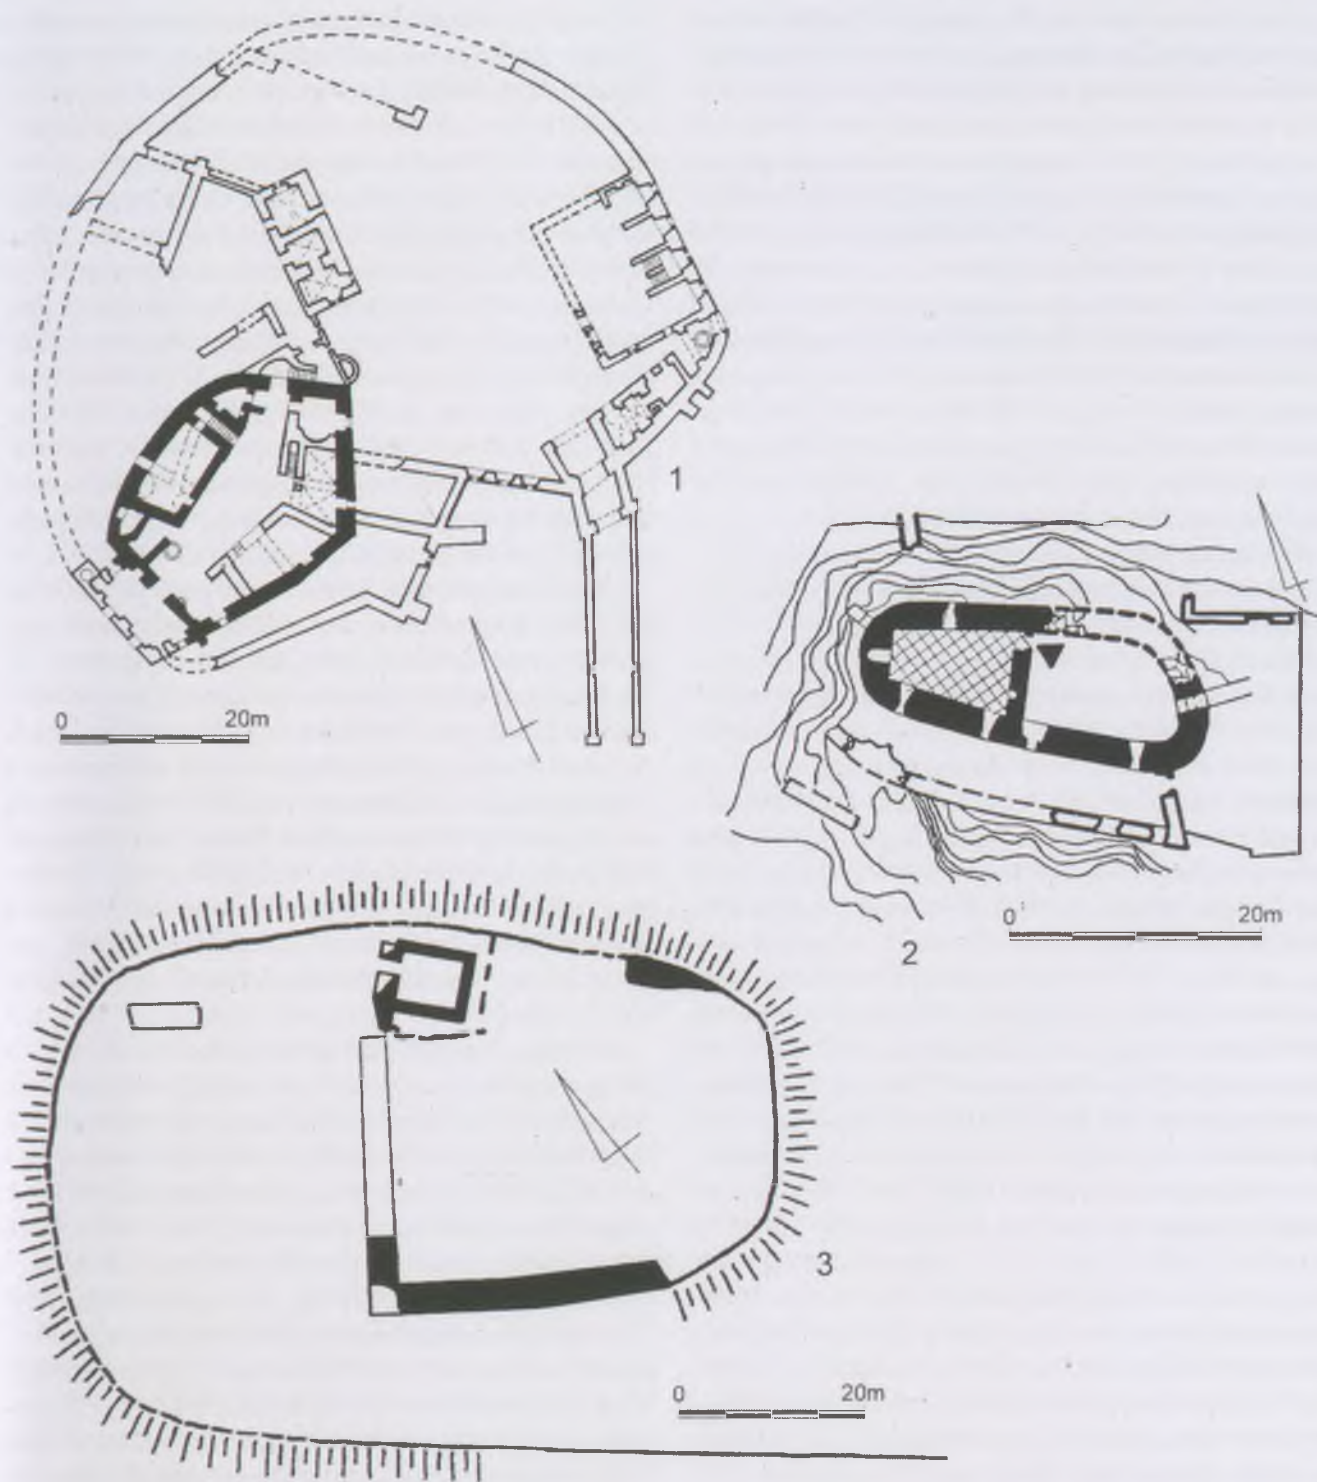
1 Burg Greiffenstein (zamek Gryf). Schwarz: Mauerwerk vom Beginn des 14. Jahrhunderts (nach Guerquin); 2 Schwerta (Swiecie). Grundriss der Kernburg (nach Chorowska); 3 Rohnau (Trzcieniec). Grundriss der Burg (nach Guerquin).
